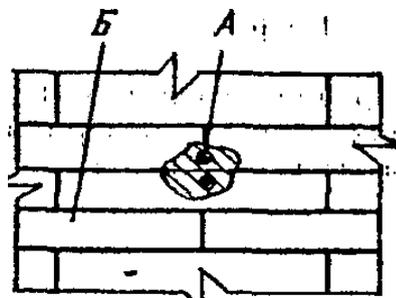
Коррозия А сварного шва, околошовной зоны, а также основного металла стенки Б на длине не более 500 мм.
